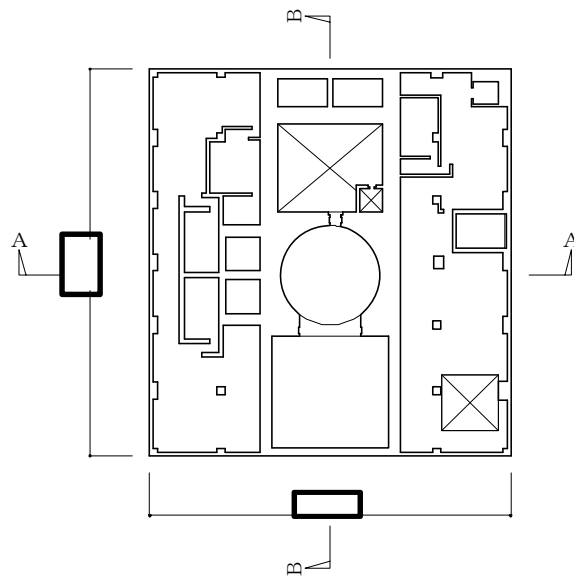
(8/9)  の概略平面図 (EL. 38.8 m)
